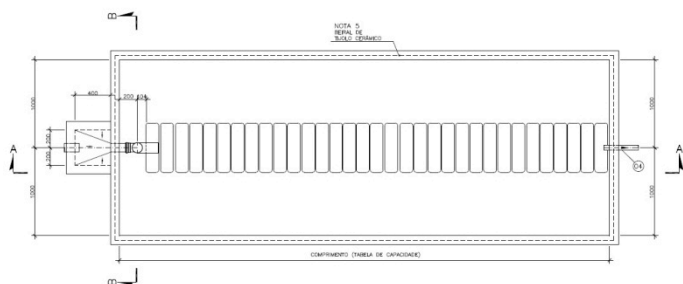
Planta baixa do TEvap projetado (COSTA, 2014)⁵.
